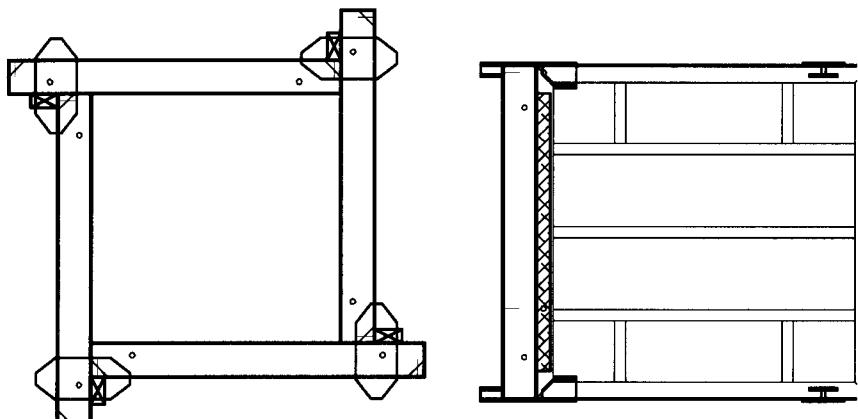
Крепление элементов опалубки стяжной проволокой и с применением накладок
